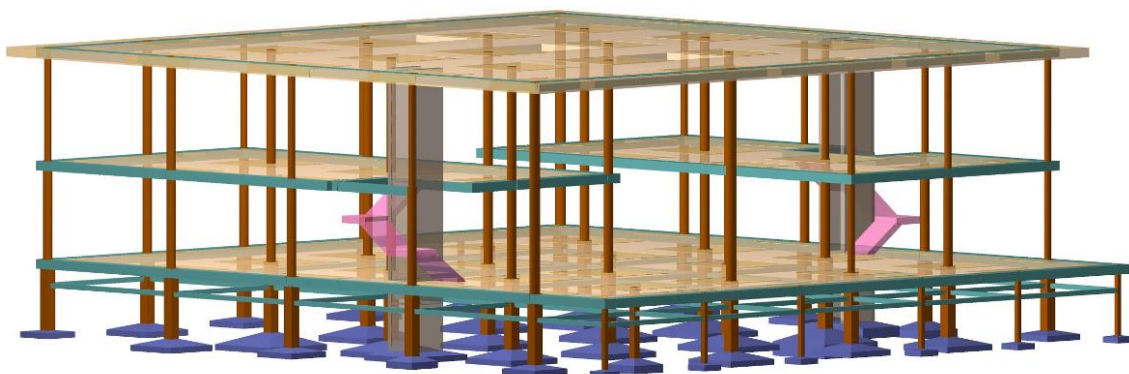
Modelo de la estructura en CypeCad. Fuente: autoría propia.
